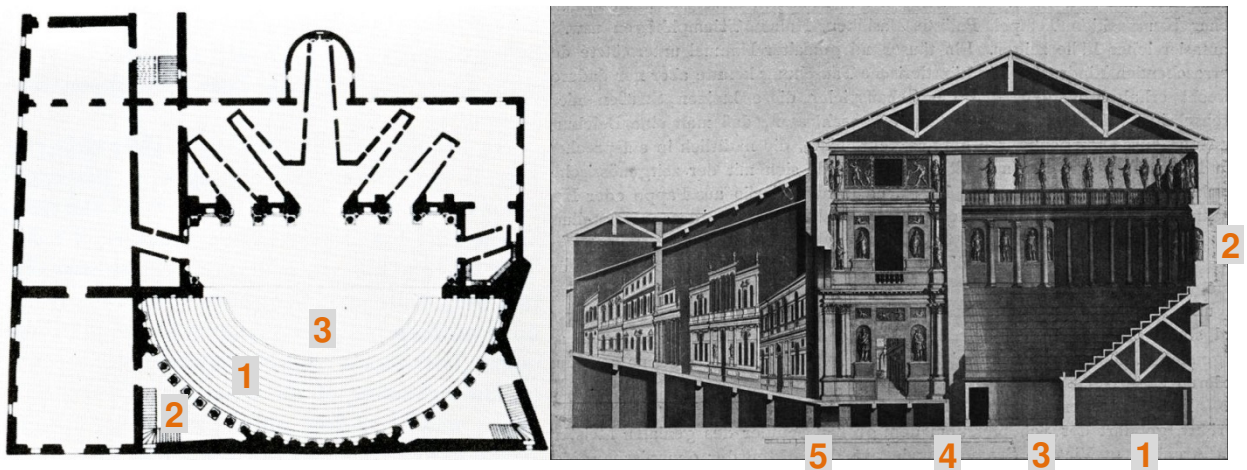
Grundriss Andrea Palladio 1585<sup>383</sup> Bild 90 Schnitt<sup>384</sup>
